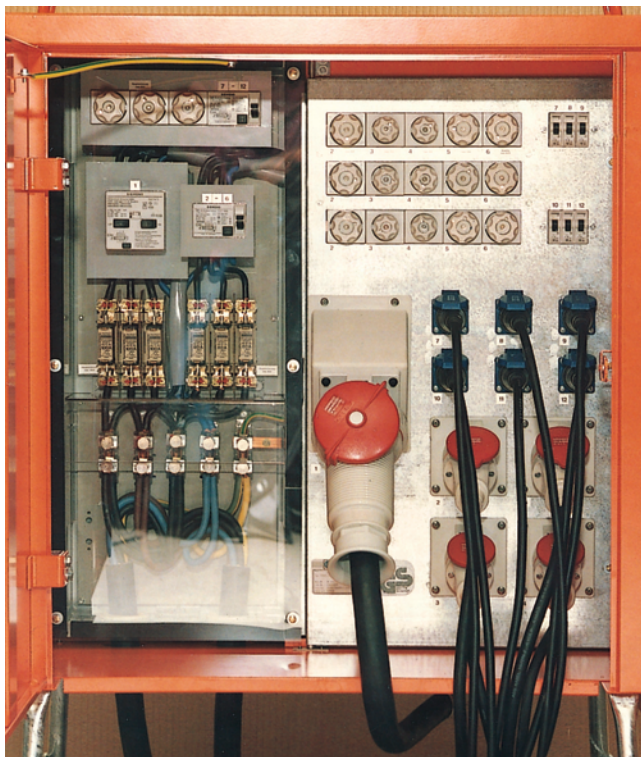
V-Schrank (Verteilerschrank), (Bosecker)
